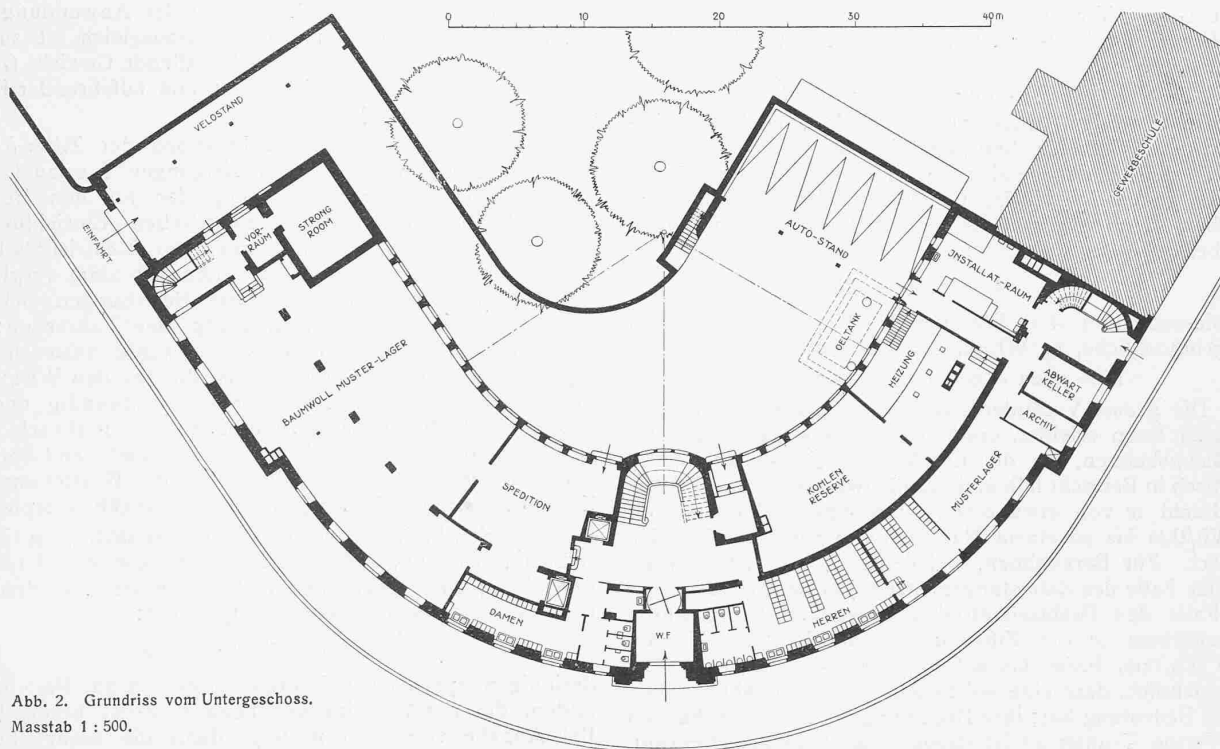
Grundriss vom Untergeschoss. Masstab 1 : 500.
